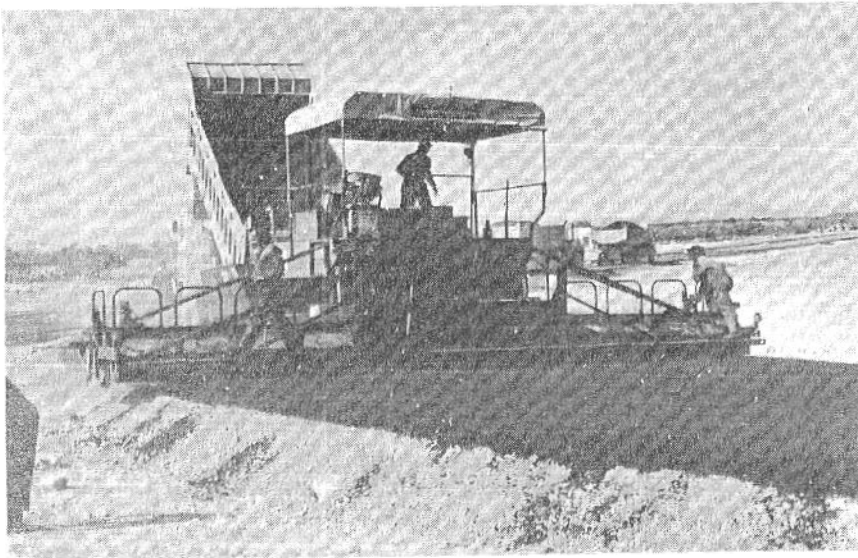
EXTENSION SIN JUNTA LONGITUDINAL
